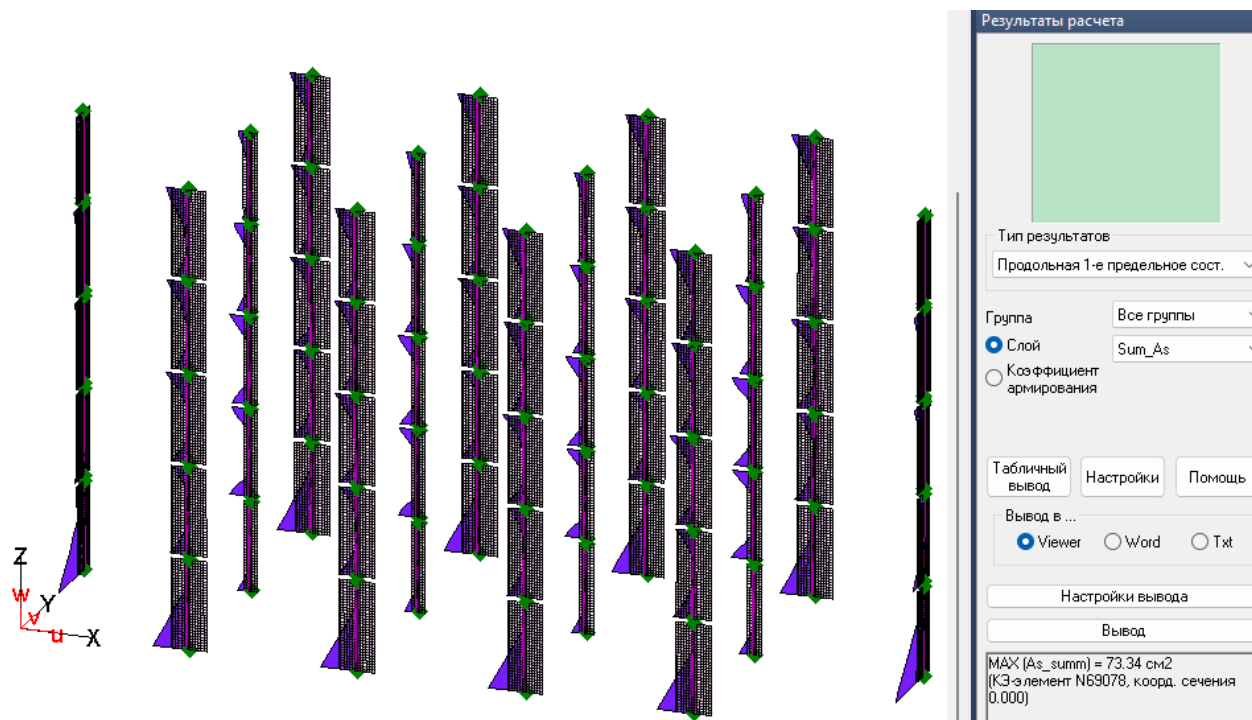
Эпюры арматуры в колоннах, кроме угловых (Схема с использованием оболочечных элементов стен по нормам Еврокода).
